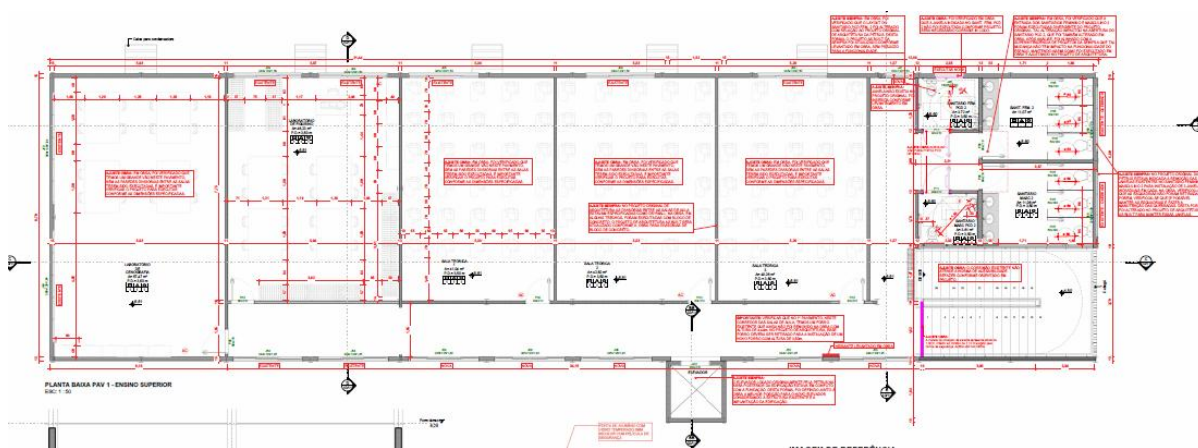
Planta Baixa Pavimento 1 – PROJETO AS BUILT
